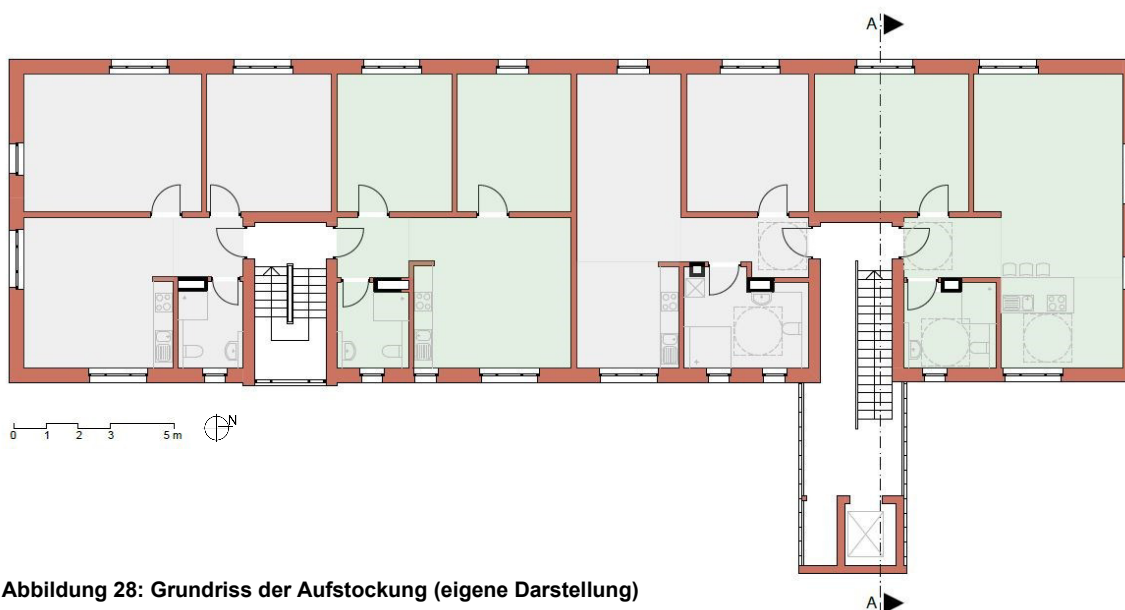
Grundriss der Aufstockung (eigene Darstellung)
